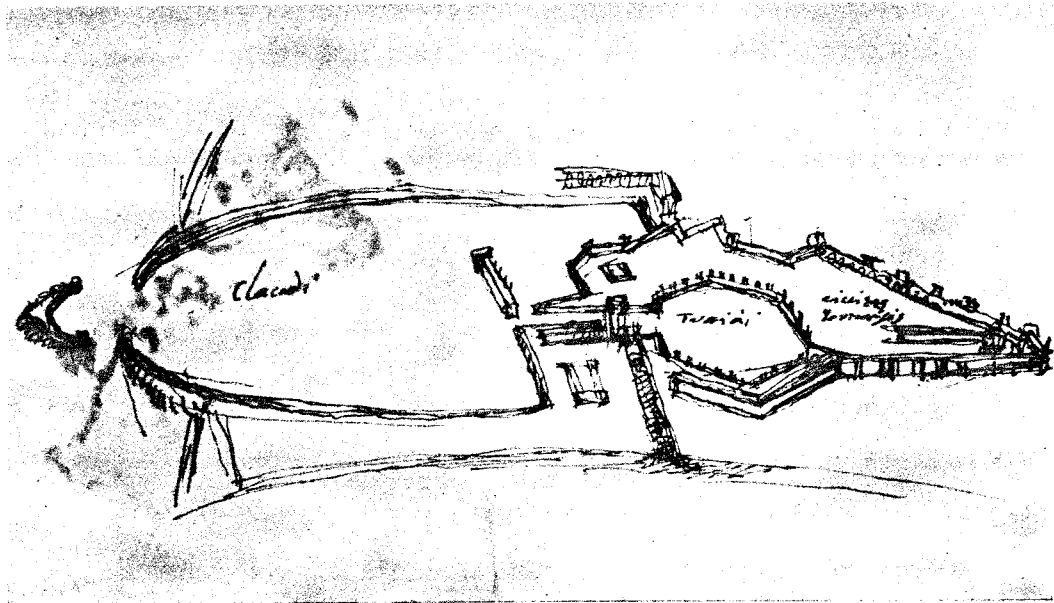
Schizzo prospettico del medesimo. (Uffizi).
